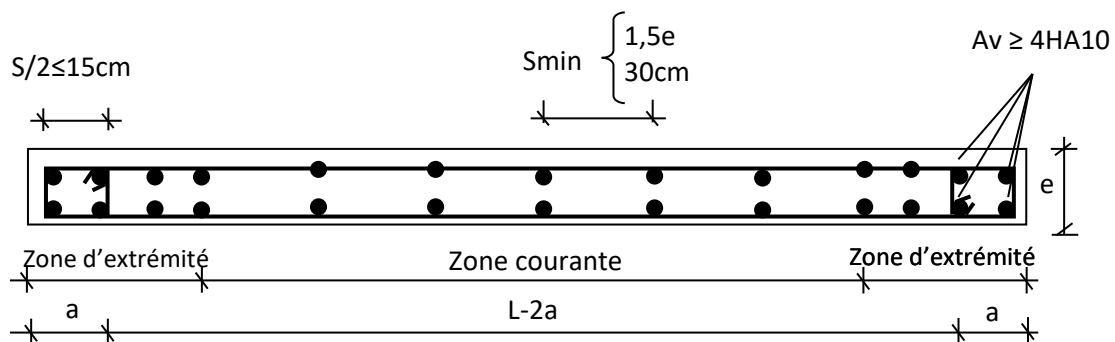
disposition des armatures verticales dans les voiles.
